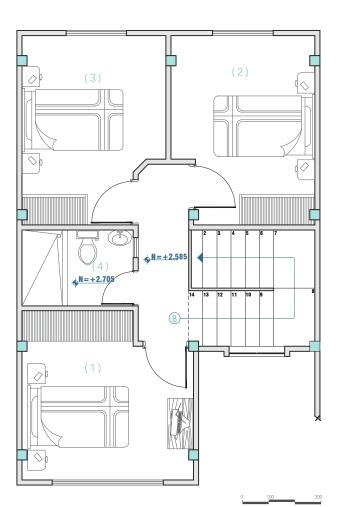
Planta baja segunda estapa Nota: Elaborado por el autor
